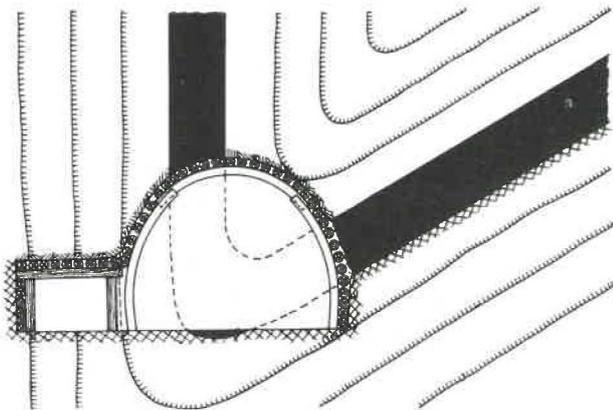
Voie de base en crochon de pied : soutènement provisoire en cadres Toussaint-Heintzmann.
